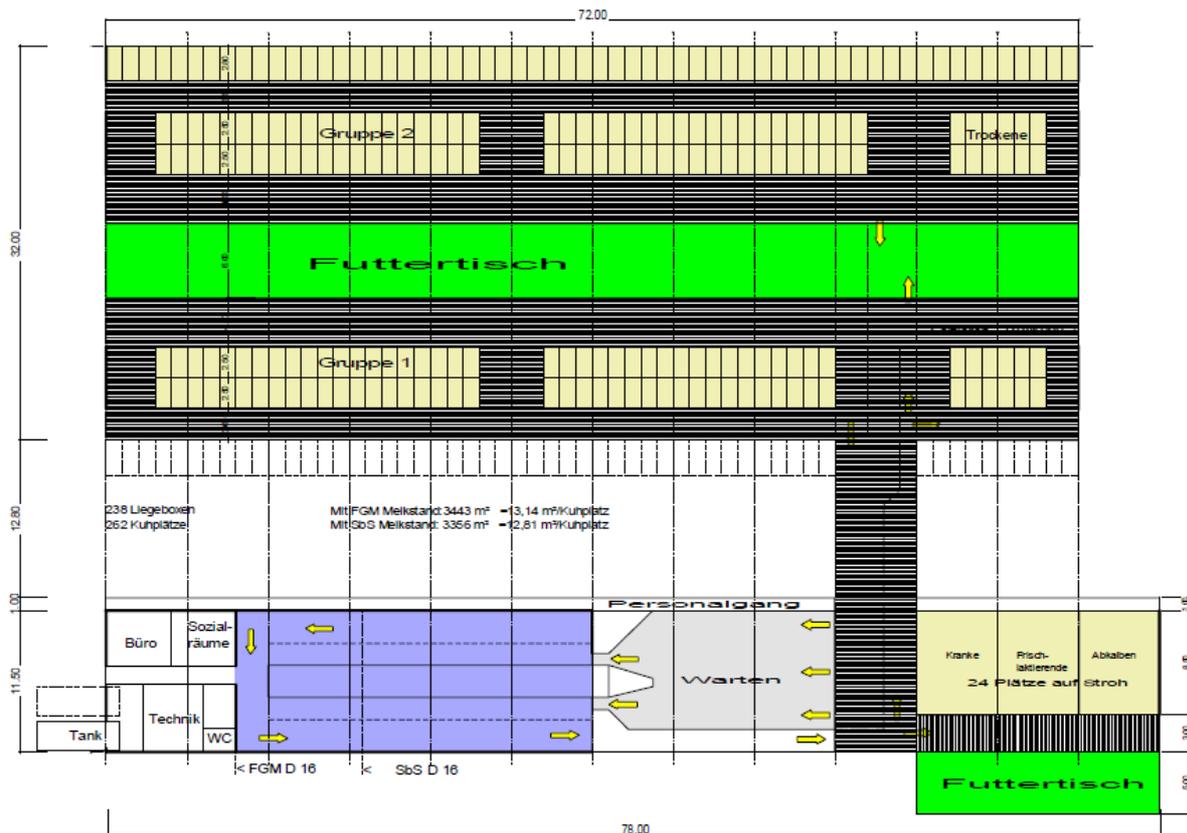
Grundriss des Musterstalls 240 MK
